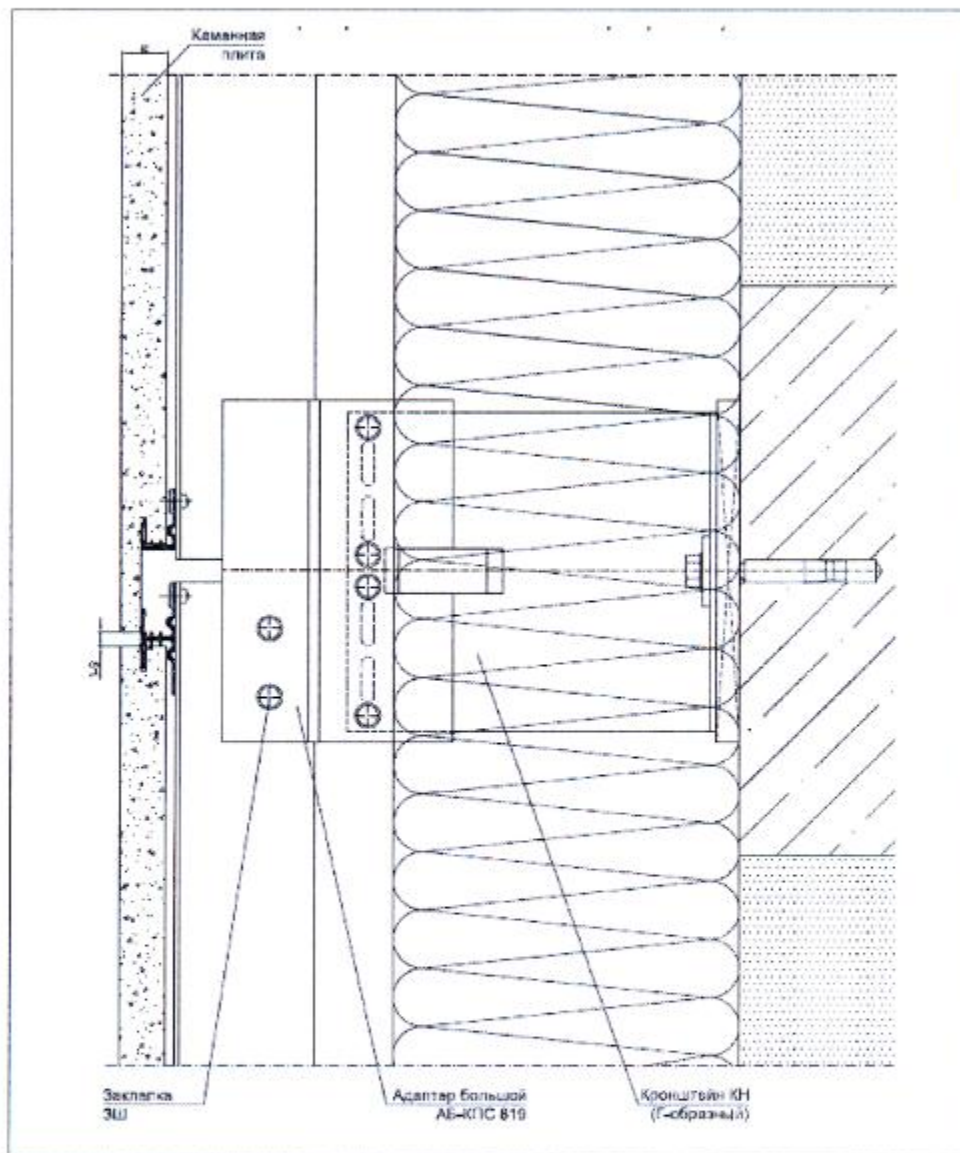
Вертикальное сечение (применение адаптера КПС 819 при креплении к плитам перекрытий)
